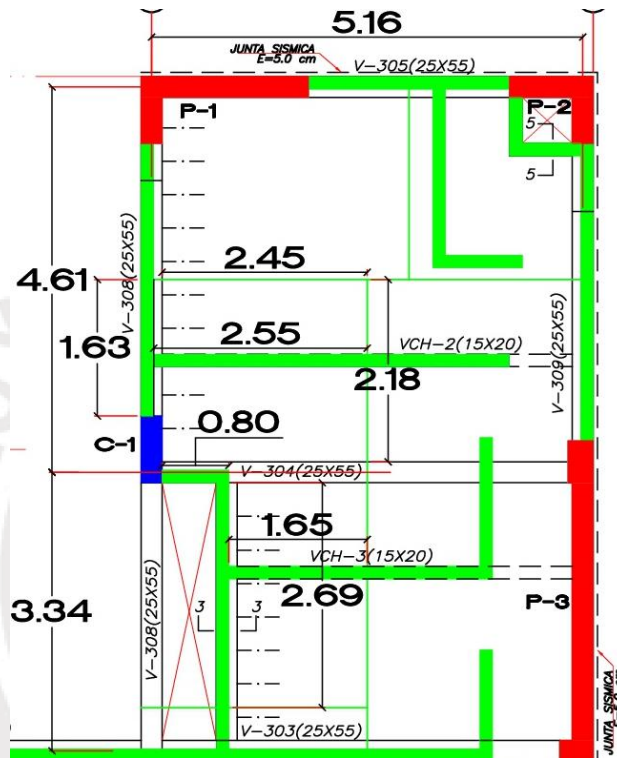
Planta de área tributaria de la columna C-1 del 2do al 5to piso
